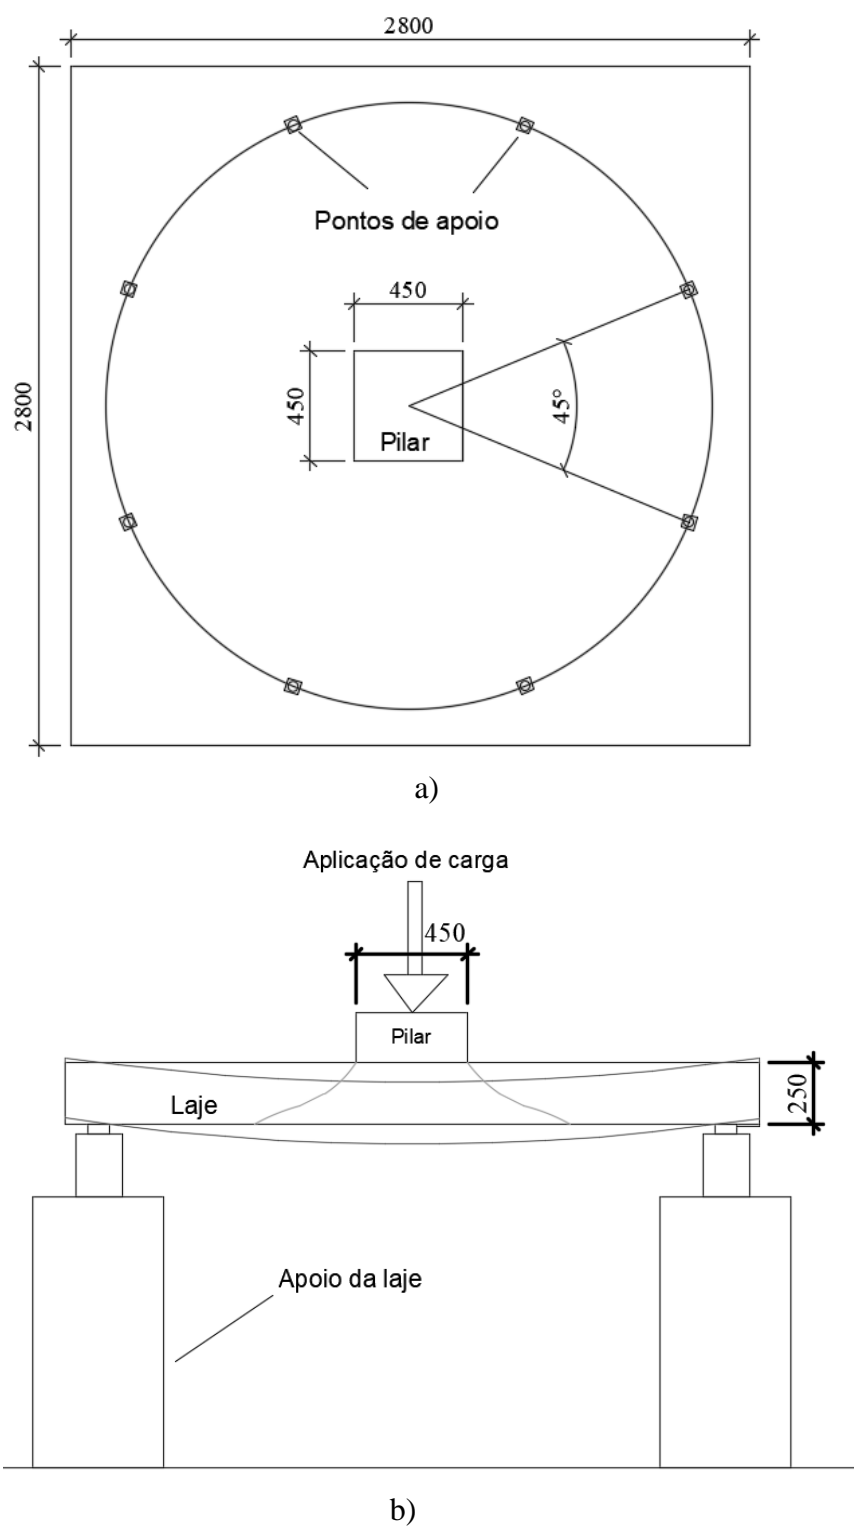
Representação da montagem e detalhe das lajes; a) Disposição dos apoios da laje; b) Detalhes dos apoios das lajes
